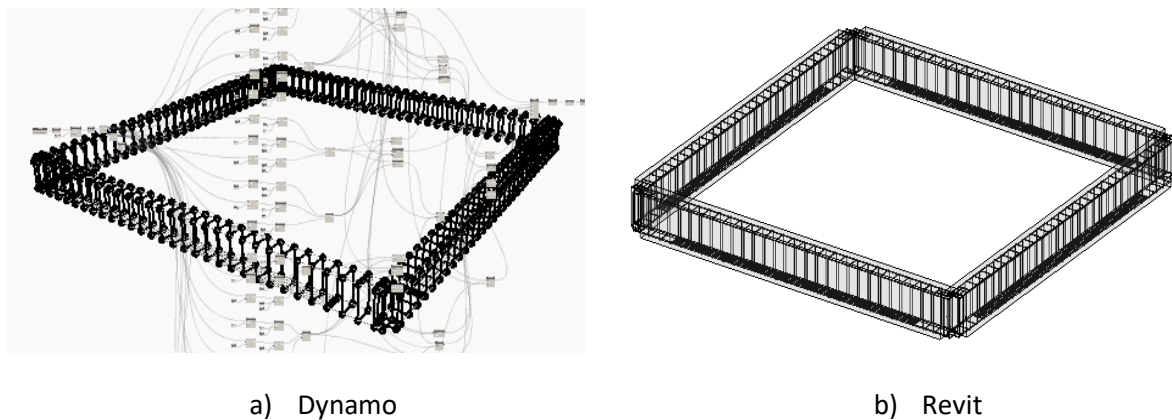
Modelação de armaduras em vigas – Dynamo/Revit
